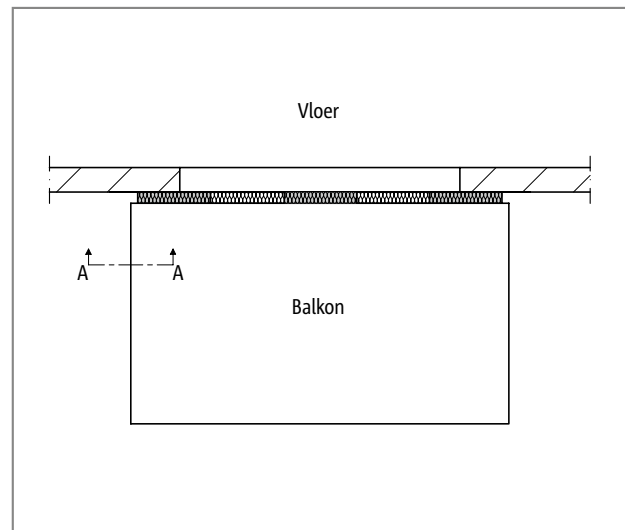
Schöck Isokorb® T type K-M12: Bijlegwapening bij indirecte ondersteuning
